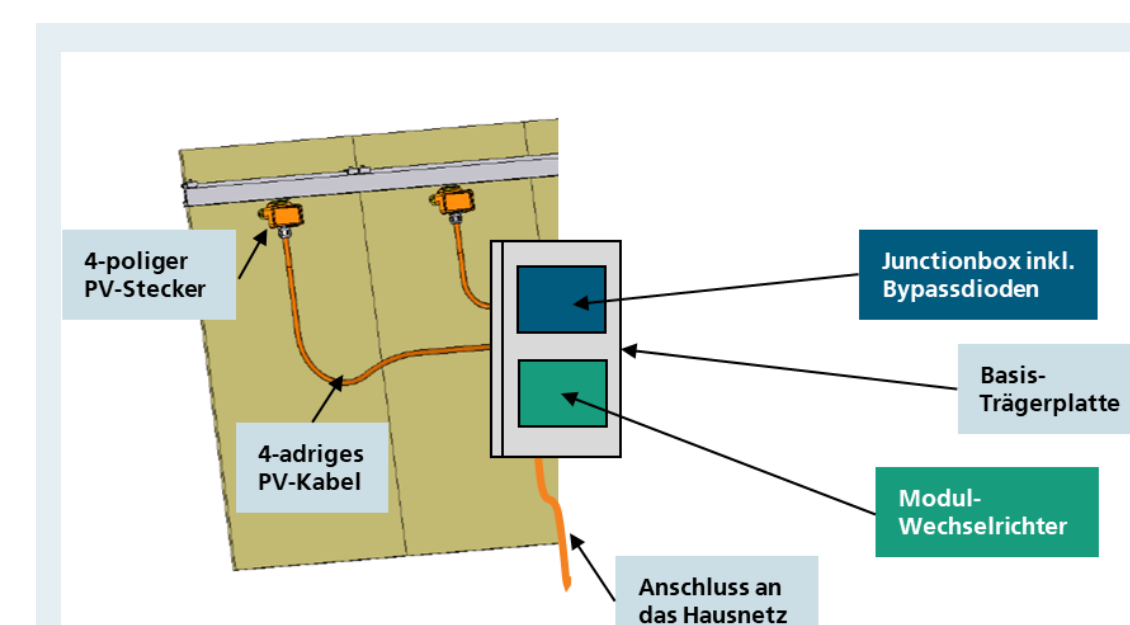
Kleinstes „virtuelles“ BIPV-Fassadenelement als 2er-Einheit
